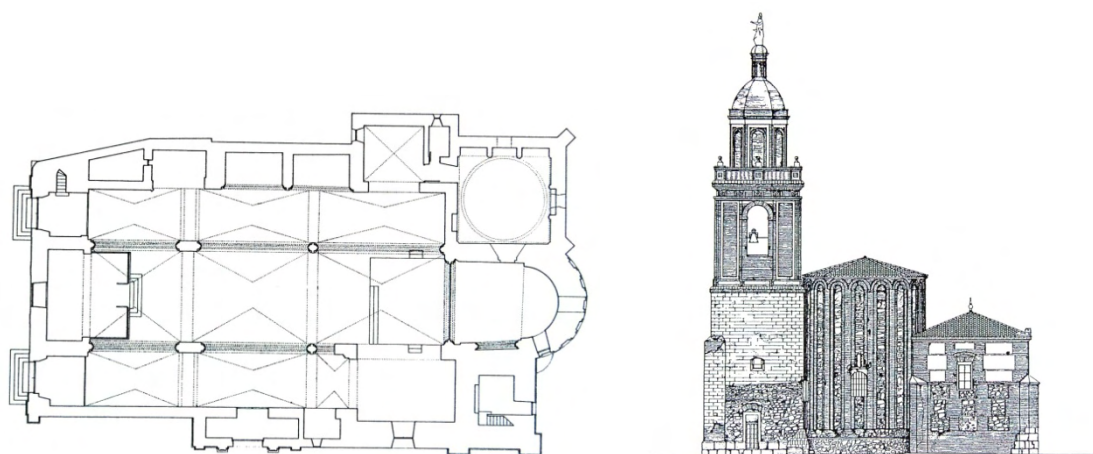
Planta baja y alzado este de Santo Domingo en Arévalo. Dibujo de Marcos Álvarez Aranz. 2002.
